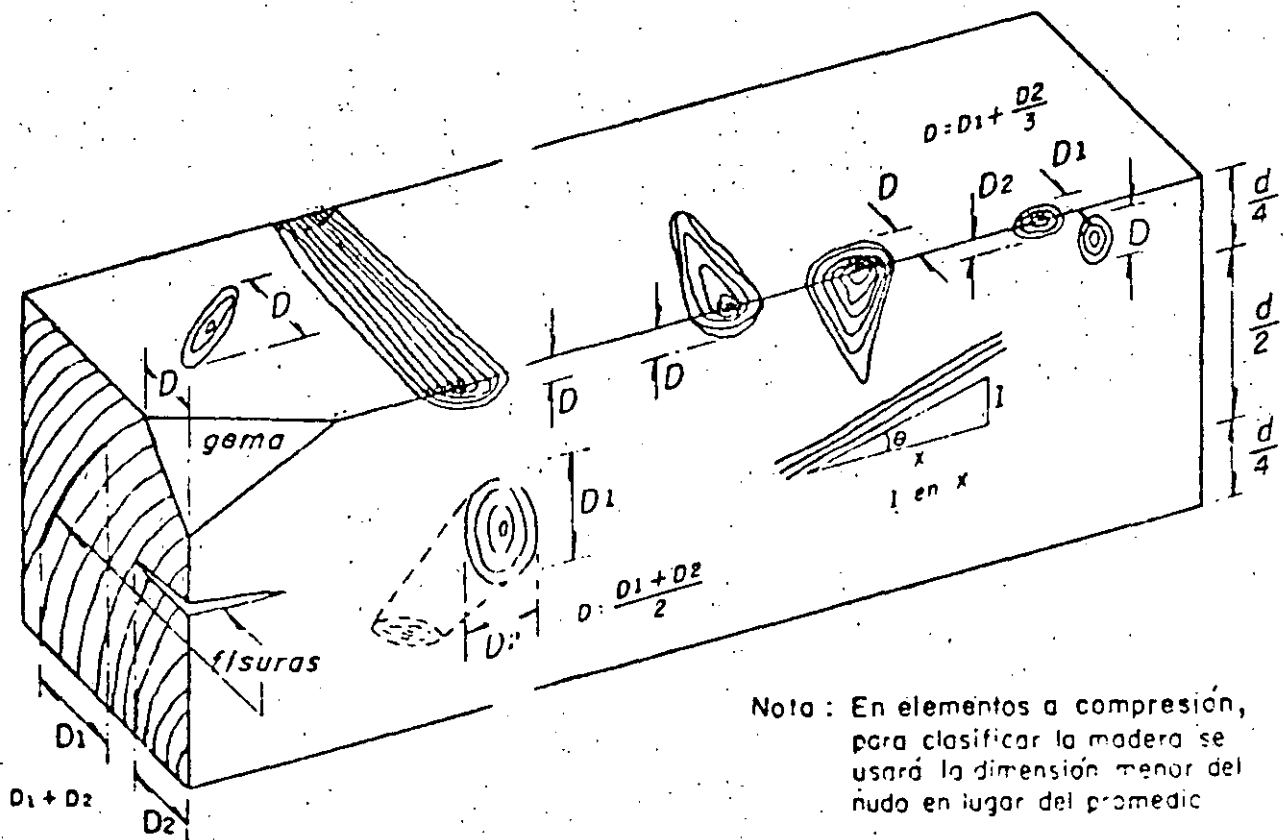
Fig I . Zonas en un elemento a flexión, para su clasificación estructural
